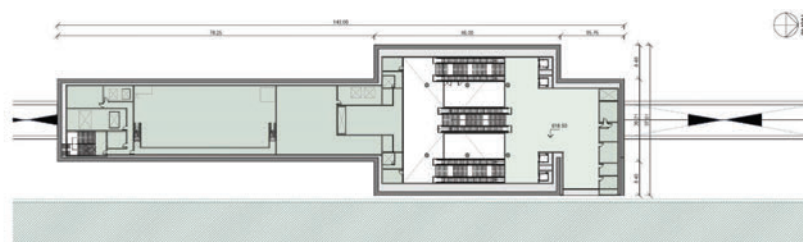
Estación Barajas T4 \_Planta Vestíbulo
